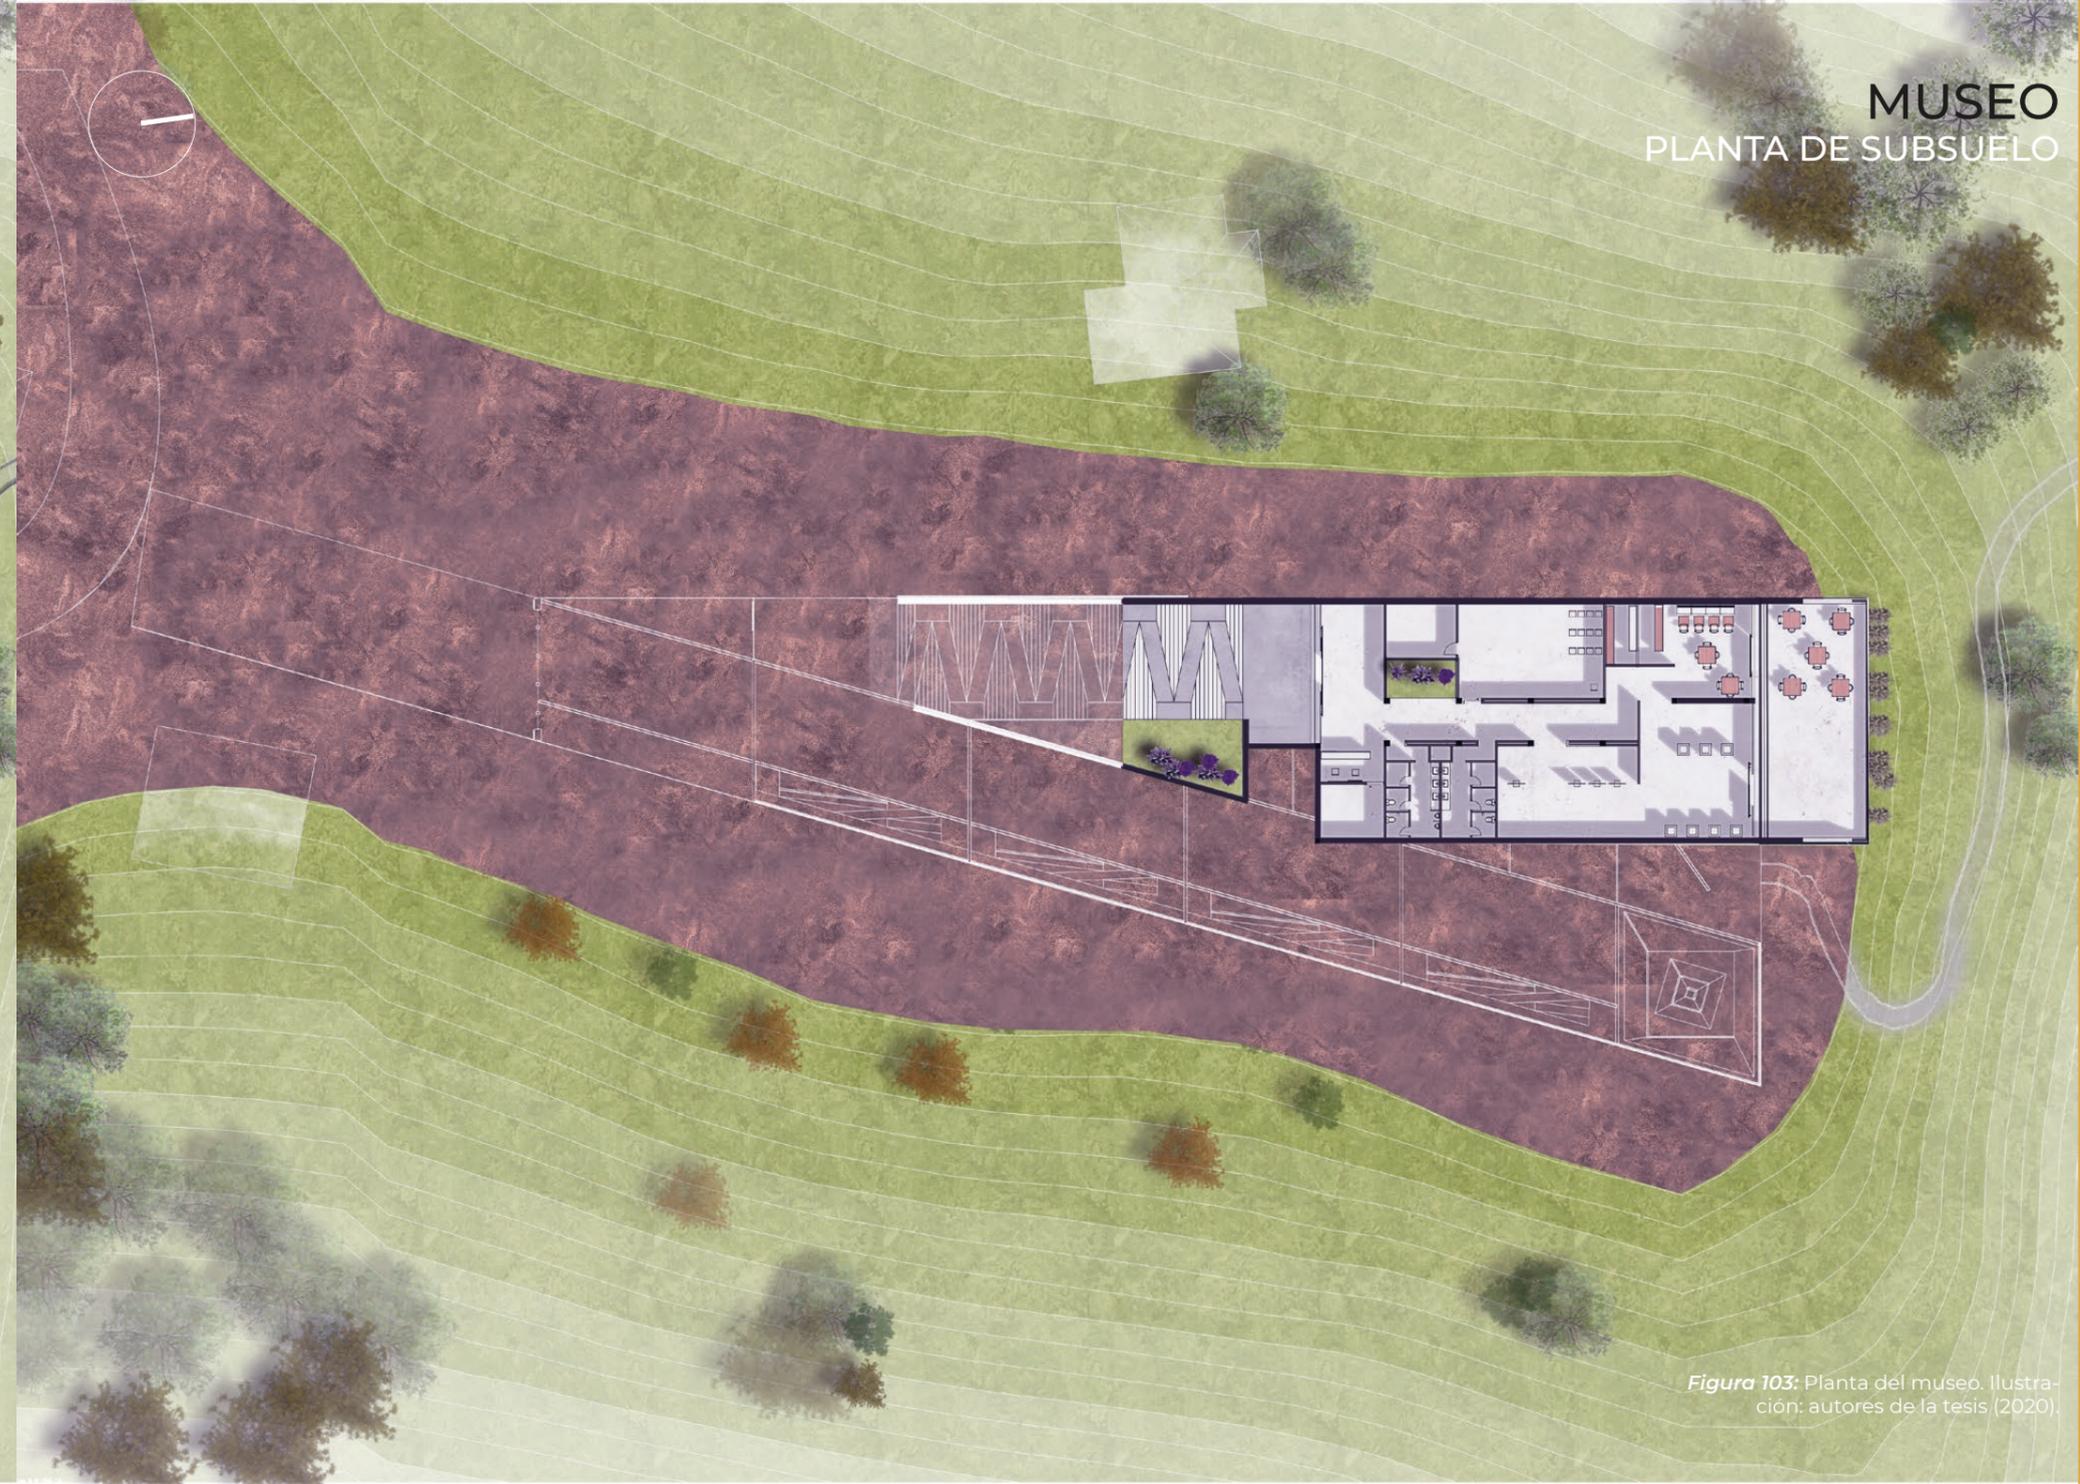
Planta del museo. Ilustración: autores de la tesis (2020).
